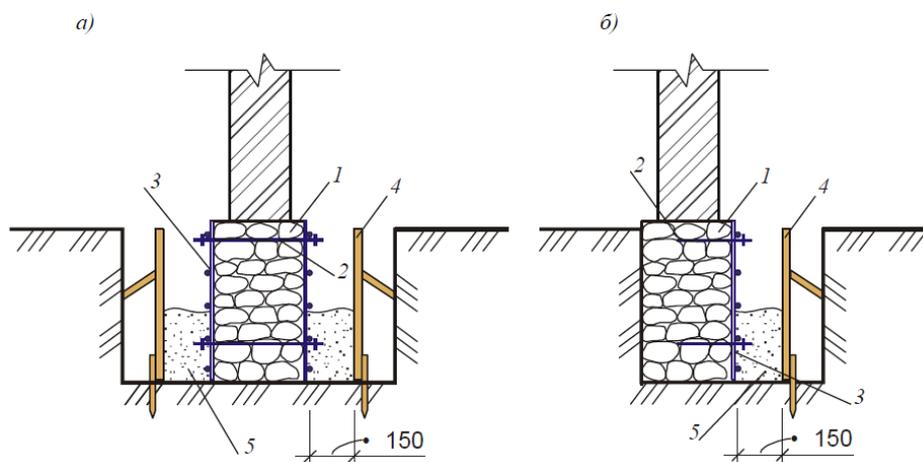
Усиление бутовых фундаментов путем устройства железобетонной обоймы:
